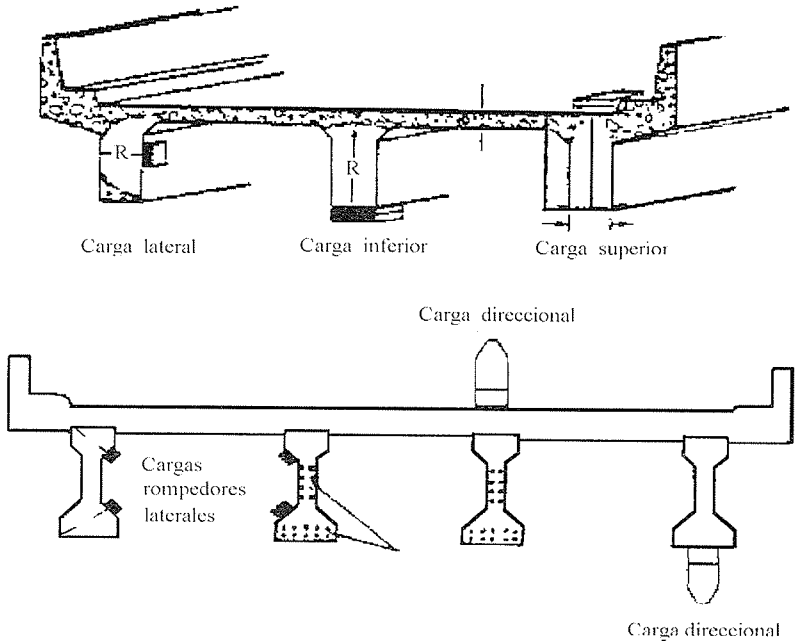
Destrucción de estructuras de hormigón armado (superior) y pretensado (inferior)
